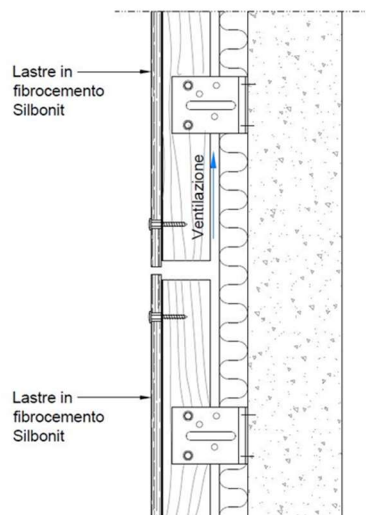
Esempio di una sezione verticale tipo del pacchetto di facciata ventilata in corrispondenza di un giunto orizzontale tra lastre. Sottostruttura di legno e rivestimento di lastre piane di fibrocemento Silbonit.
